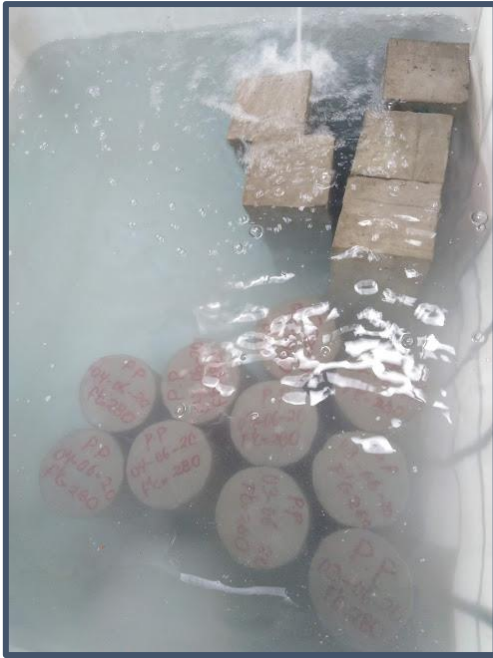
Probetas y vigas de concreto patrón cumpliendo sus edades de curado
